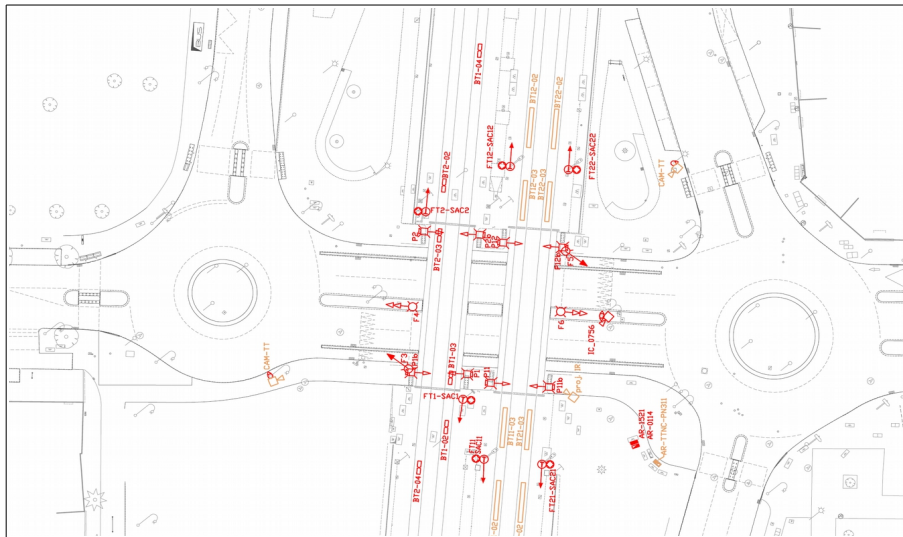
Plan du carrefour Haluchère (source : Nantes Métropole)
